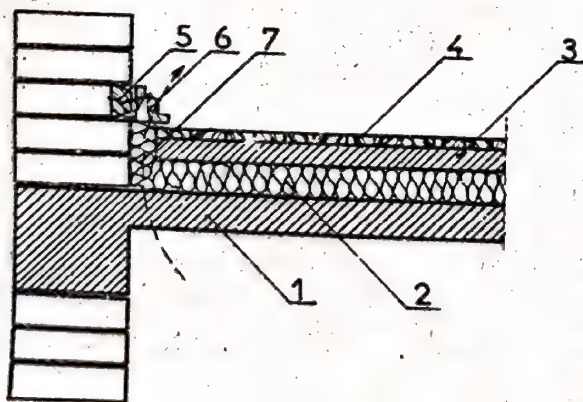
Pardoseală pe dală flotantă; 1-planșeu beton armat; 2-izolație acustică;
